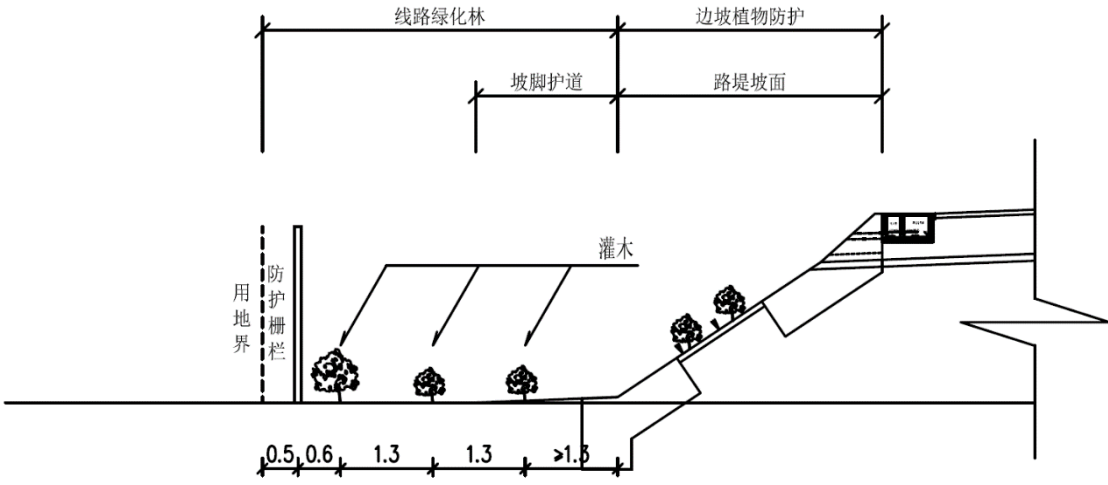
无排水沟路堤地段绿化断面示意图（边坡高度<3m）
